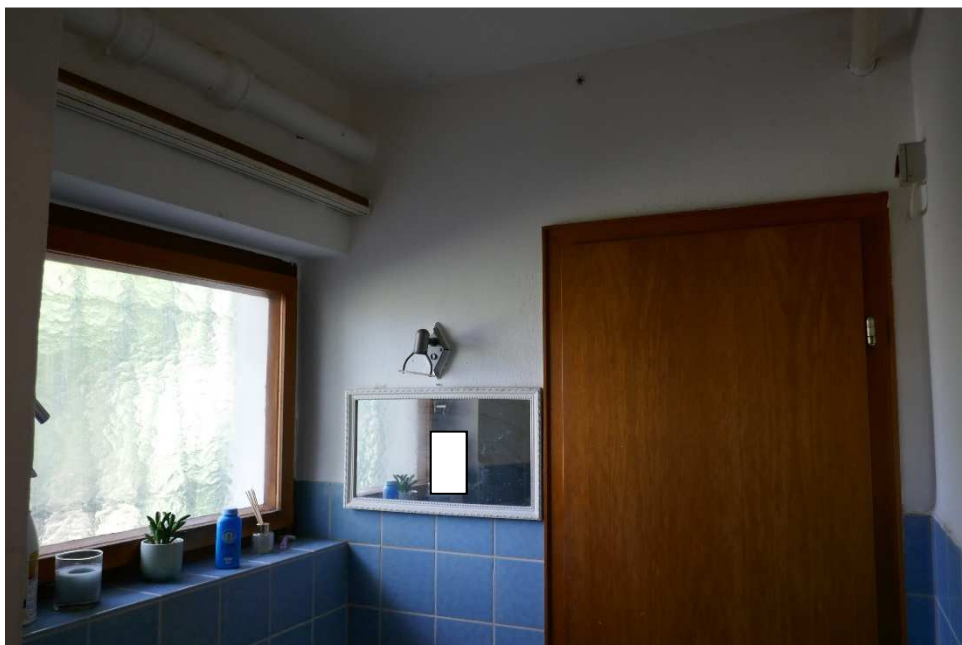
“Obergeschoss, Anbau (ca. 1966)“
